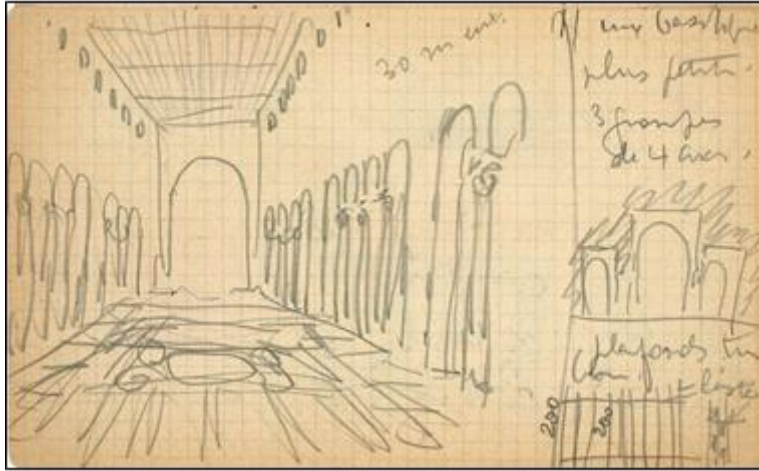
Assembly Meclis Sarayı, Hindistan
